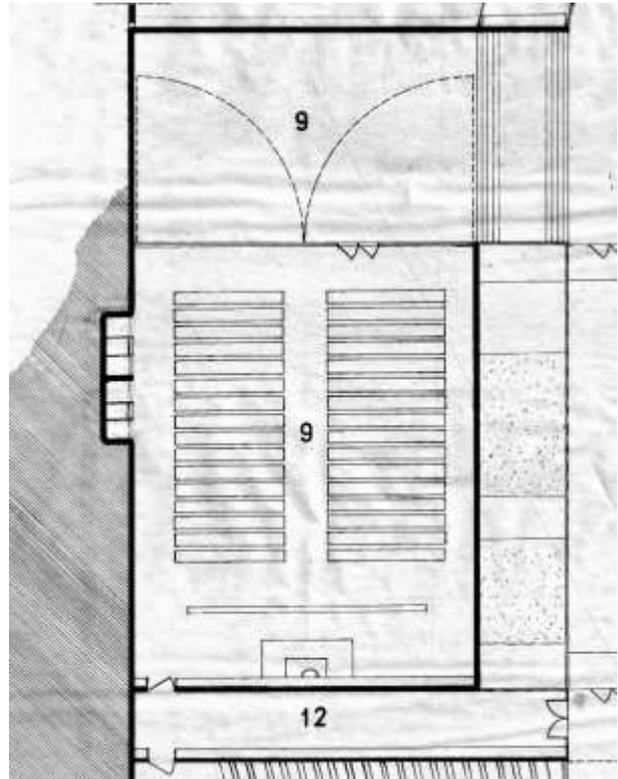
/ Detalle Planta N0 lám. 16853 DDI-IH
